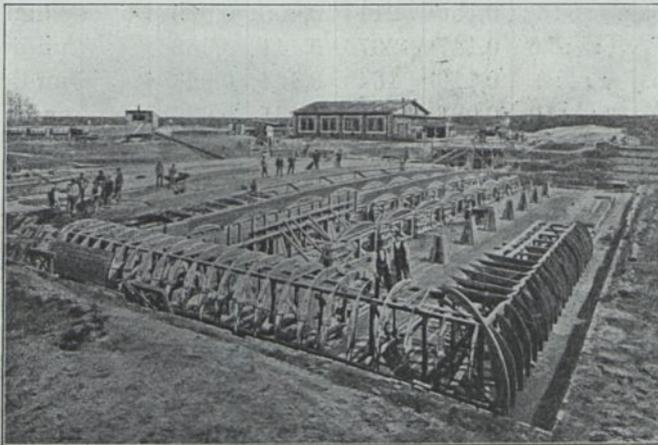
Lehrgerüstbau für das Abwasser-Sammelbecken der Kieler Werft.
